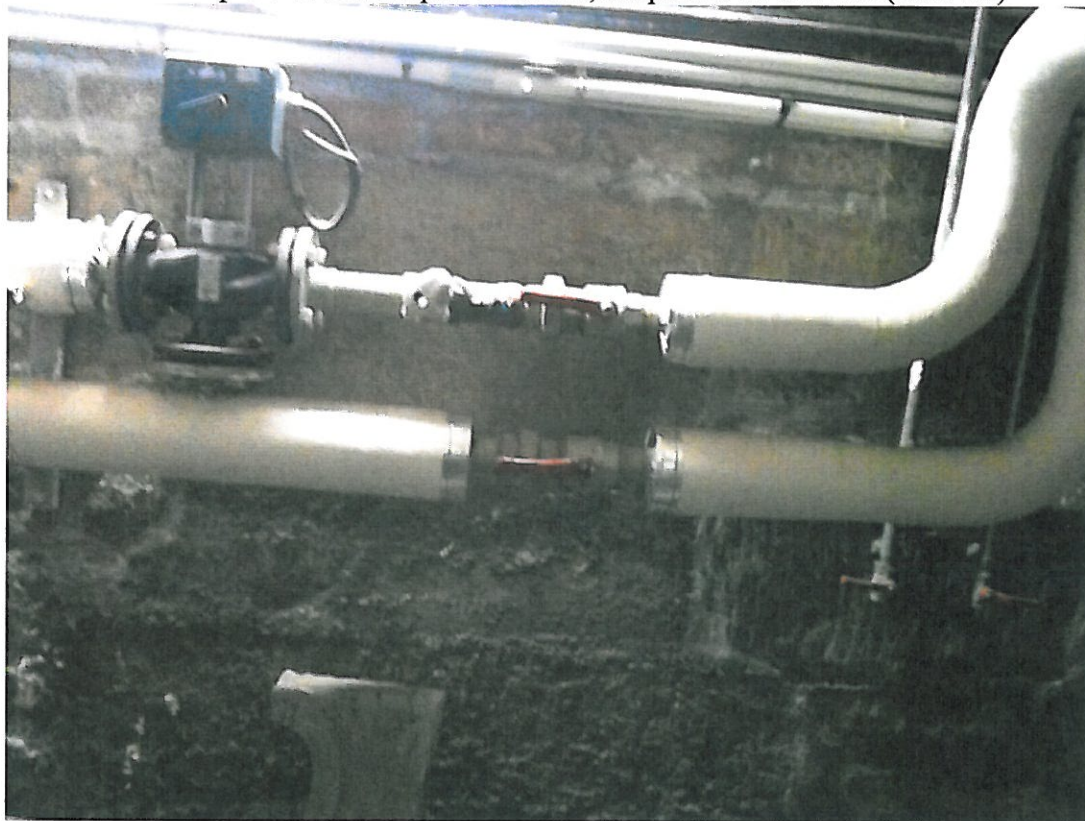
trace de fuite et moisissures sur les murs porteur de façade (sous sol)
